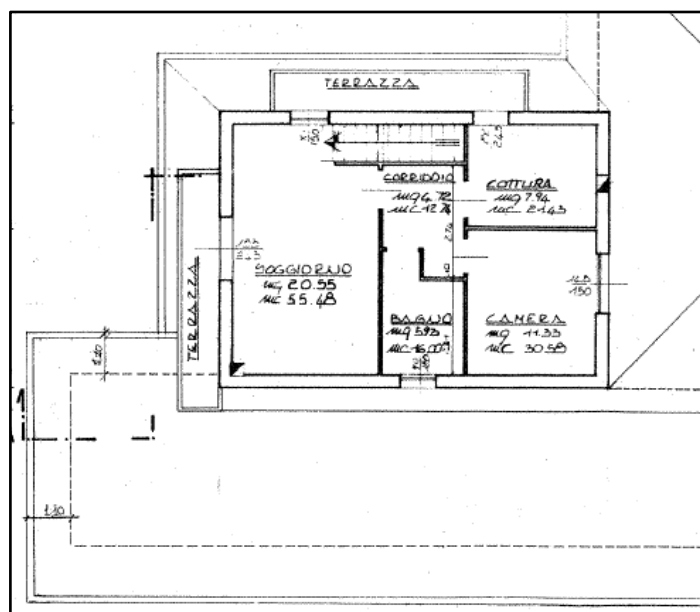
Concessione edilizia n. 1635 del 2001, pianta di progetto del primo piano
